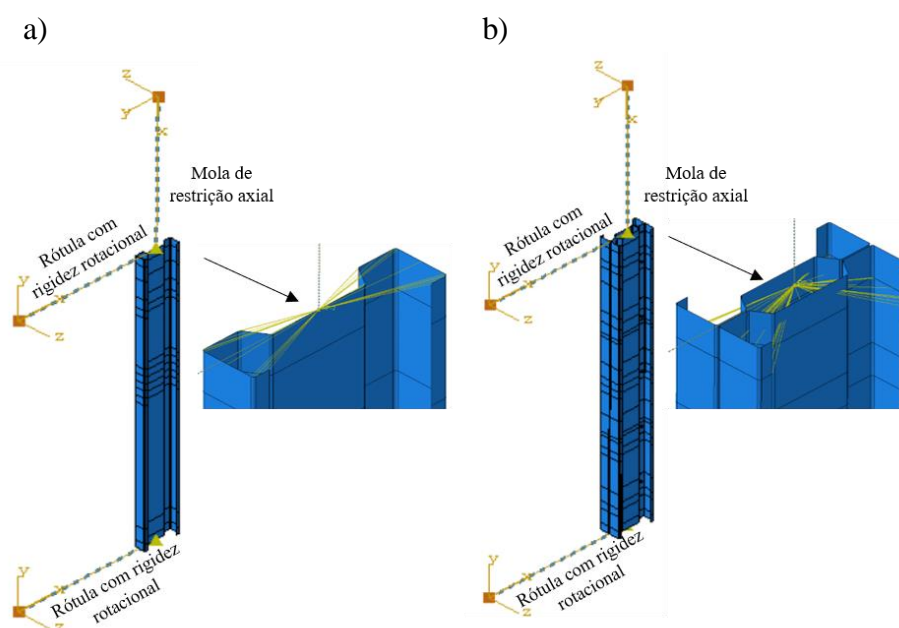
Modelos estruturais em situação de incêndio: a) Secção Σ ; b) Secção 2Σ
